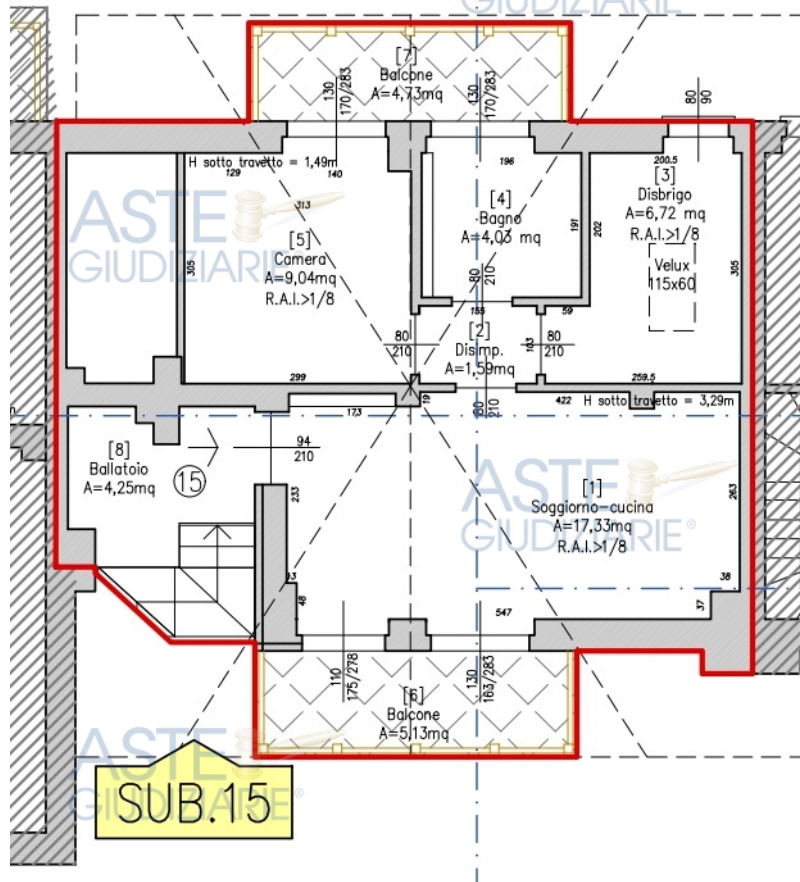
Estratto Tav.A04 S.C.I.A Prot. 15716 del 18.11.2025 – Piano primo
